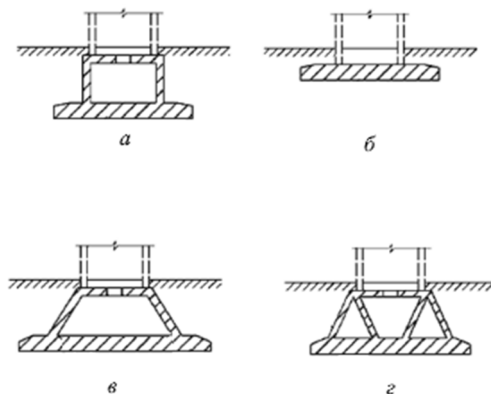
Виды фундаментов водонапорных башен по конструкции
